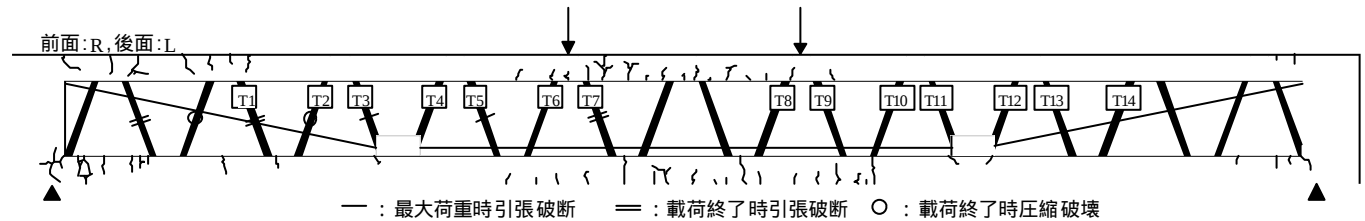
試験体のひび割れおよび斜材の破壊状況図（軽量コンクリート）
